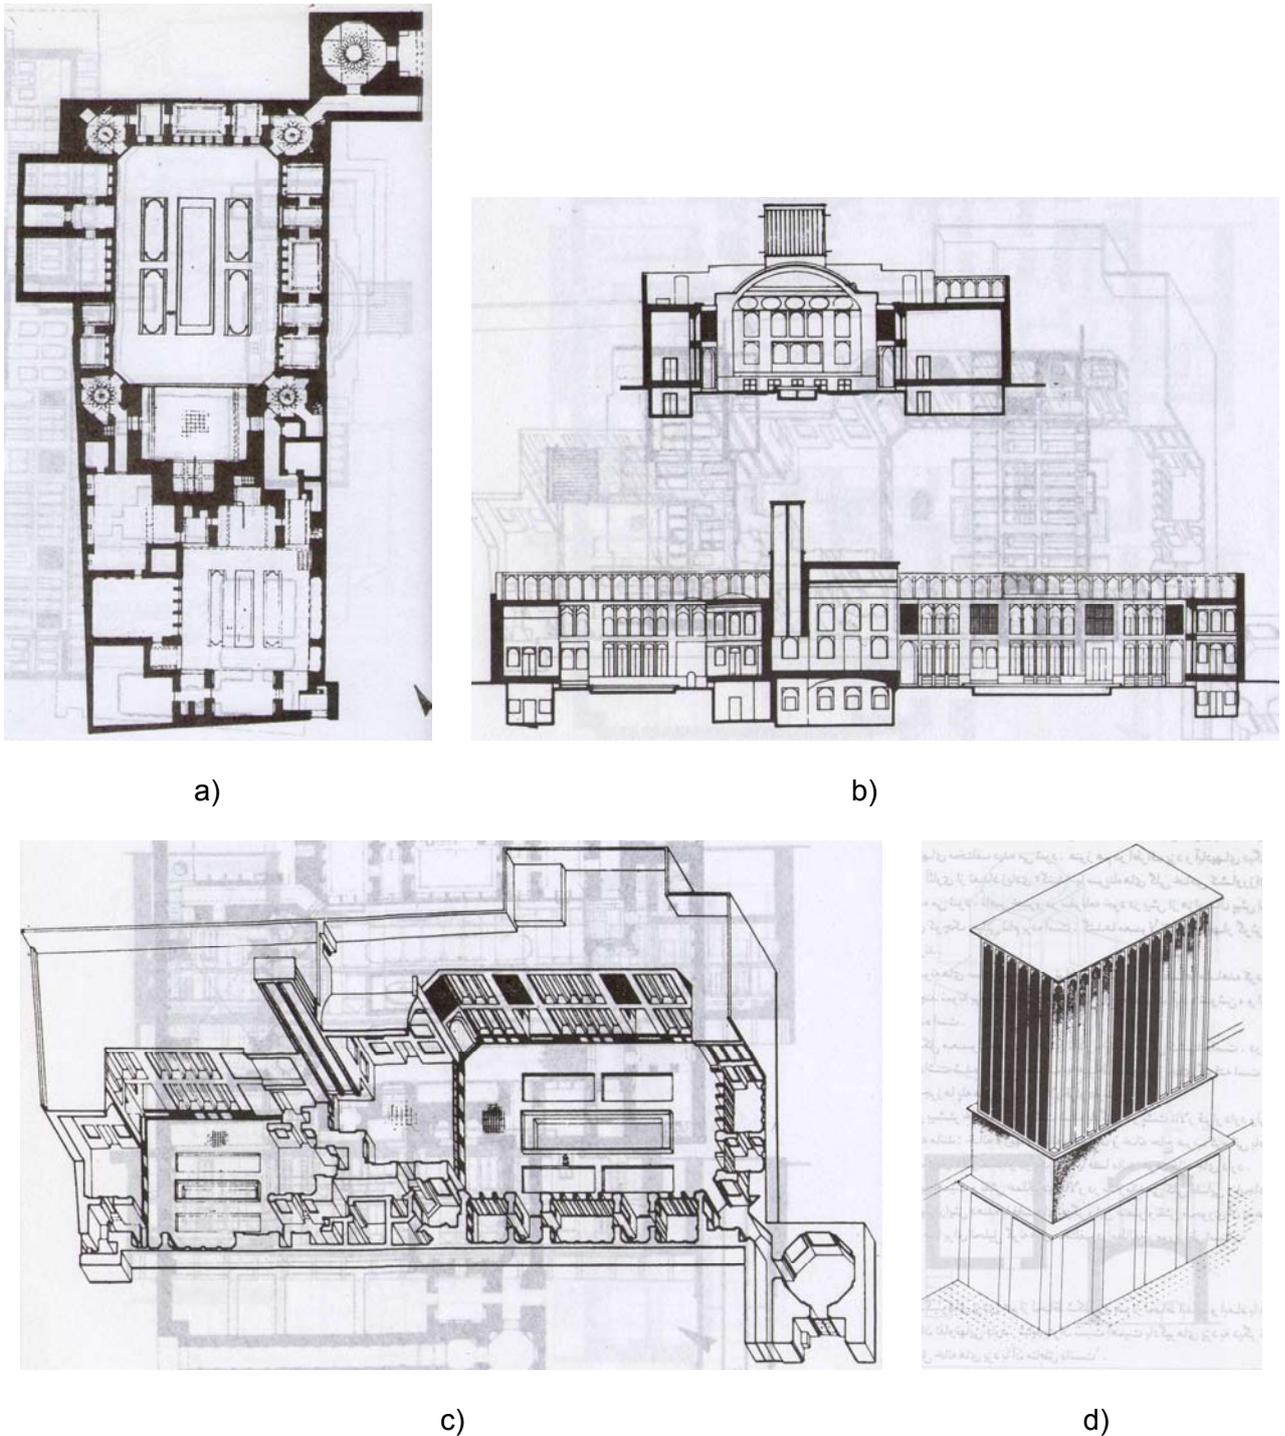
(a-d). Бадгир, Иран: а) план; б) фасад, разрез; в) общий вид; д) элементы бадгира
